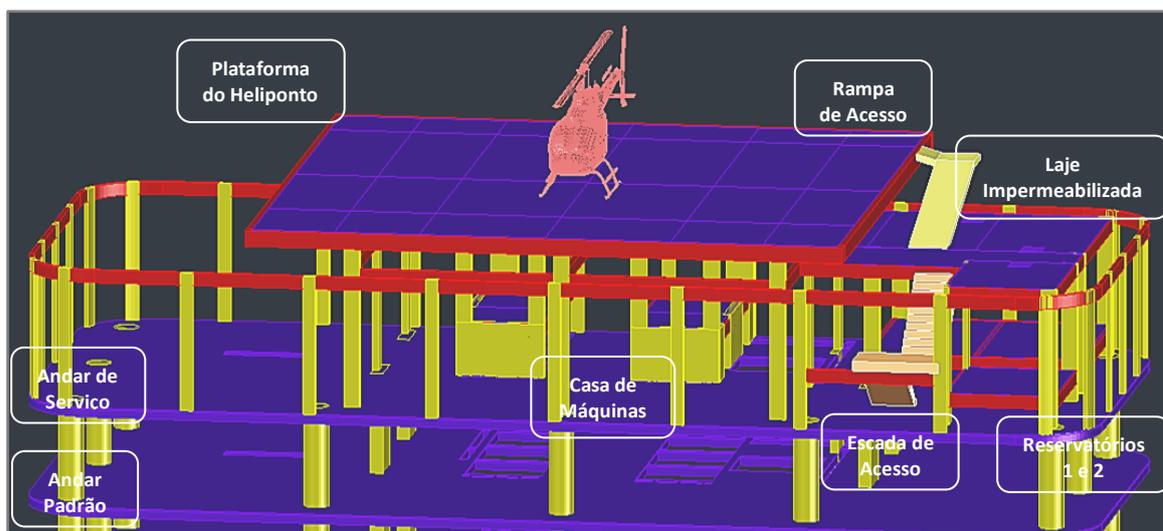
Tipologia arquitetônica e características estruturais de projeto de heliponto elevado do tipo padrão em 3D. Desenho do autor
